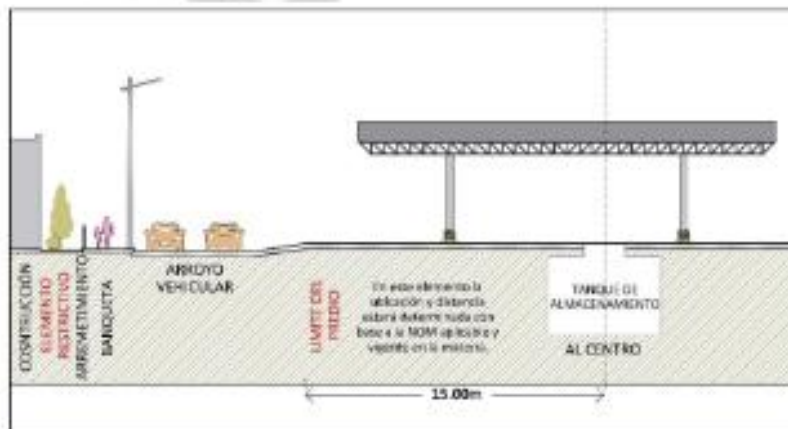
Elementos restrictivos para Estación de Servicio de Gas Natural Comprimado tipo D-1 y D-2.
